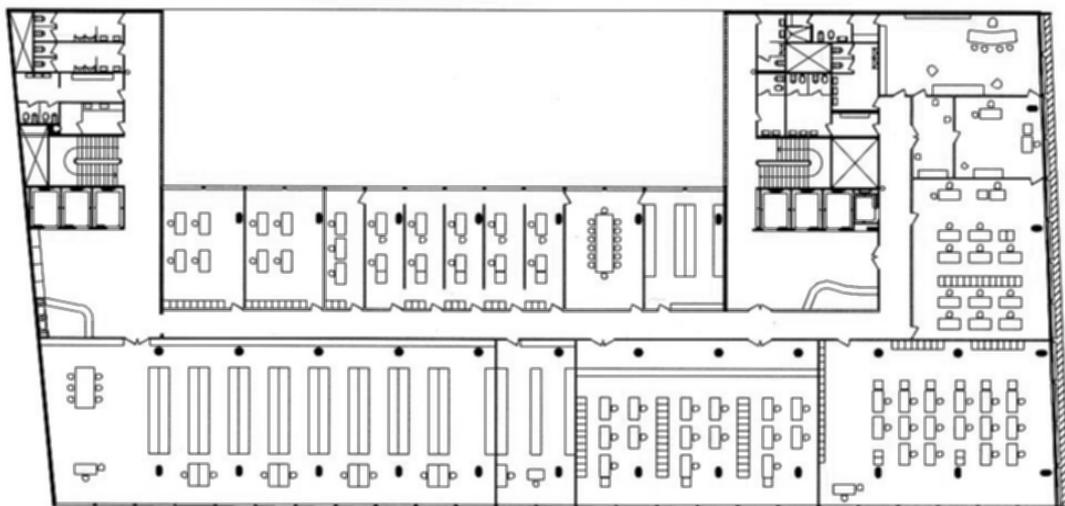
Planta dos nove pavimentos-tipo: planta livre em forma de U achatado.
